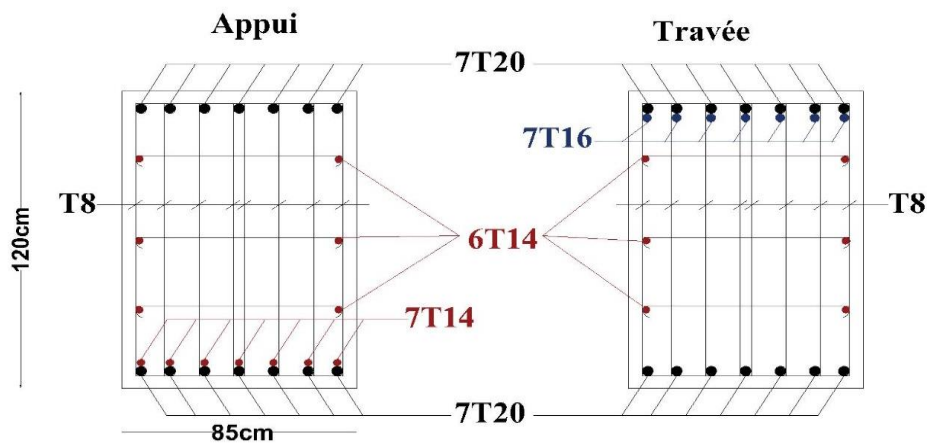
Ferrailage des nervures suivant X-X et Y-Y
